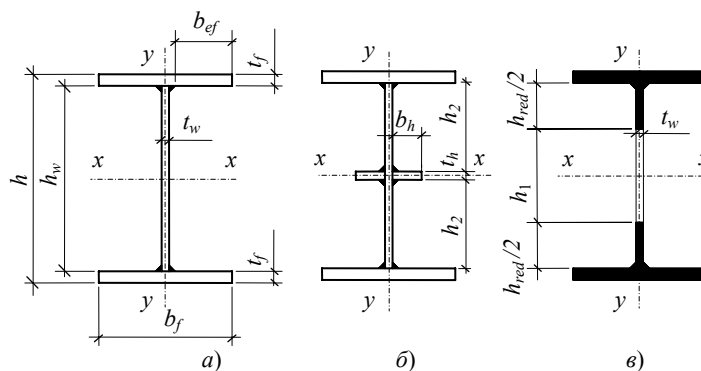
Расчётные сечения колонны двутаврового сечения в расчёте на местную устойчивость стенки
